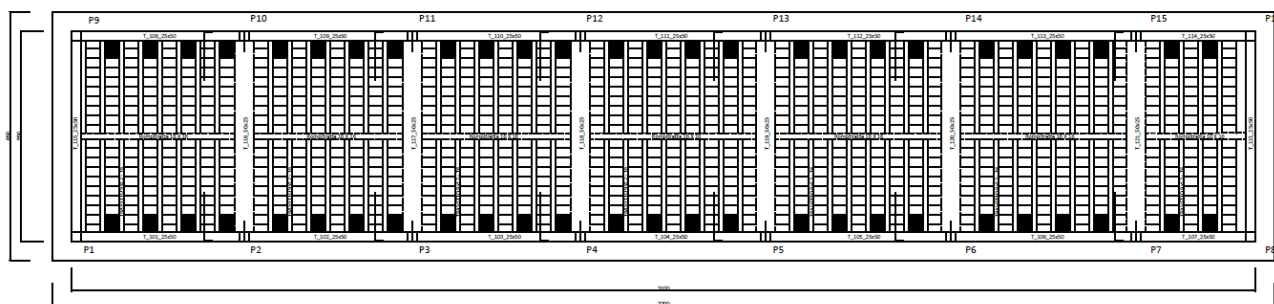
Carpenteria piano terra: disposizione dei telai e orditura solai (Strutturale)
